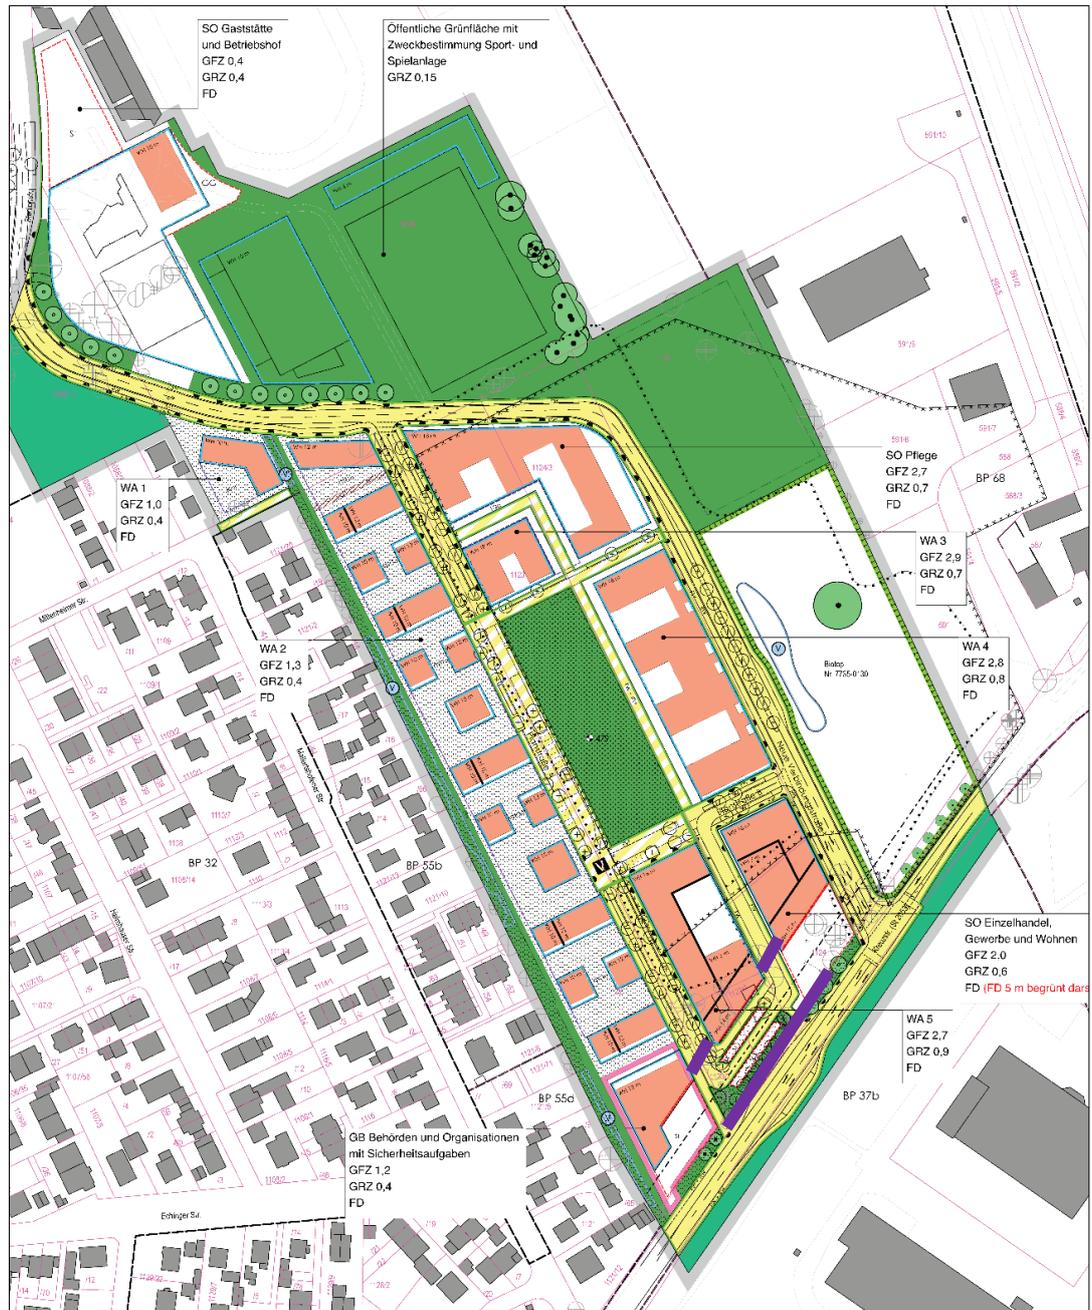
Planentwurf Bebauungsplan Nr. 273 der Stadt Unterschleißheim [15], Lage der Abschirmeinrichtungen (lila) Dragomir Stadtplanung, Stand 16.03.2023.
